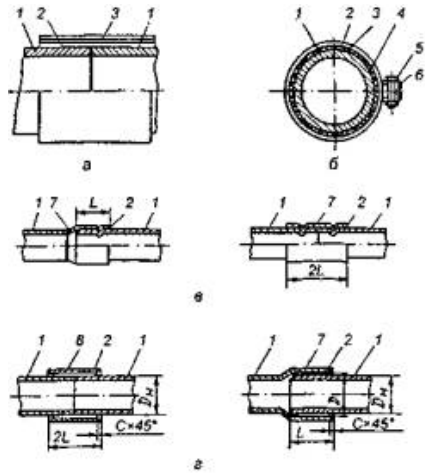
Схемы клеевых соединений трубопроводов: а - бандажного типа; б - бандаж из металлической ленты; в - клеемеханического типа; г - муфтового и раструбного типов; 1 - склеиваемые трубы; 2 - клей; 3 - стеклоткань; 4 - бандаж из металлической ленты; 5 - резьбовое соединение; 6 - вкладыш; 7 - раструб; 8 - муфта
